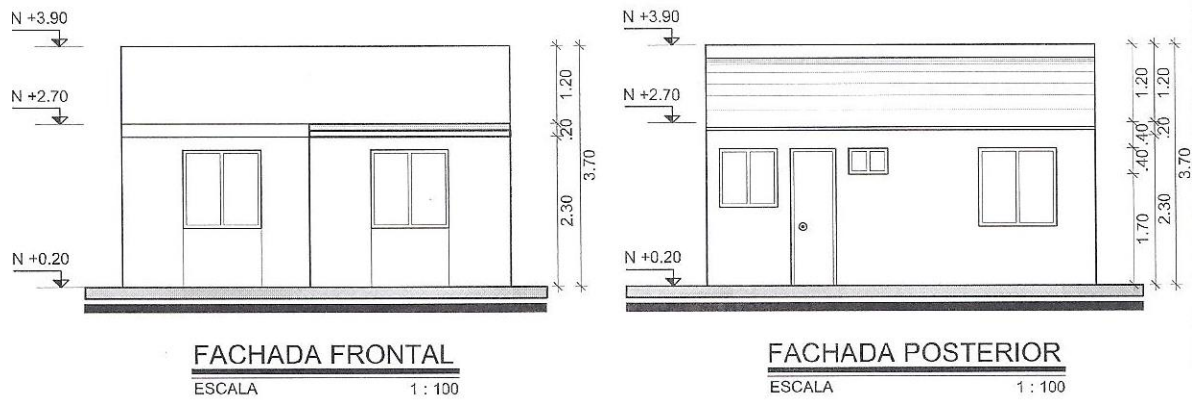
Arquitectura. Concepción de las fachadas de la vivienda de tipo emergente. MIDUVI
